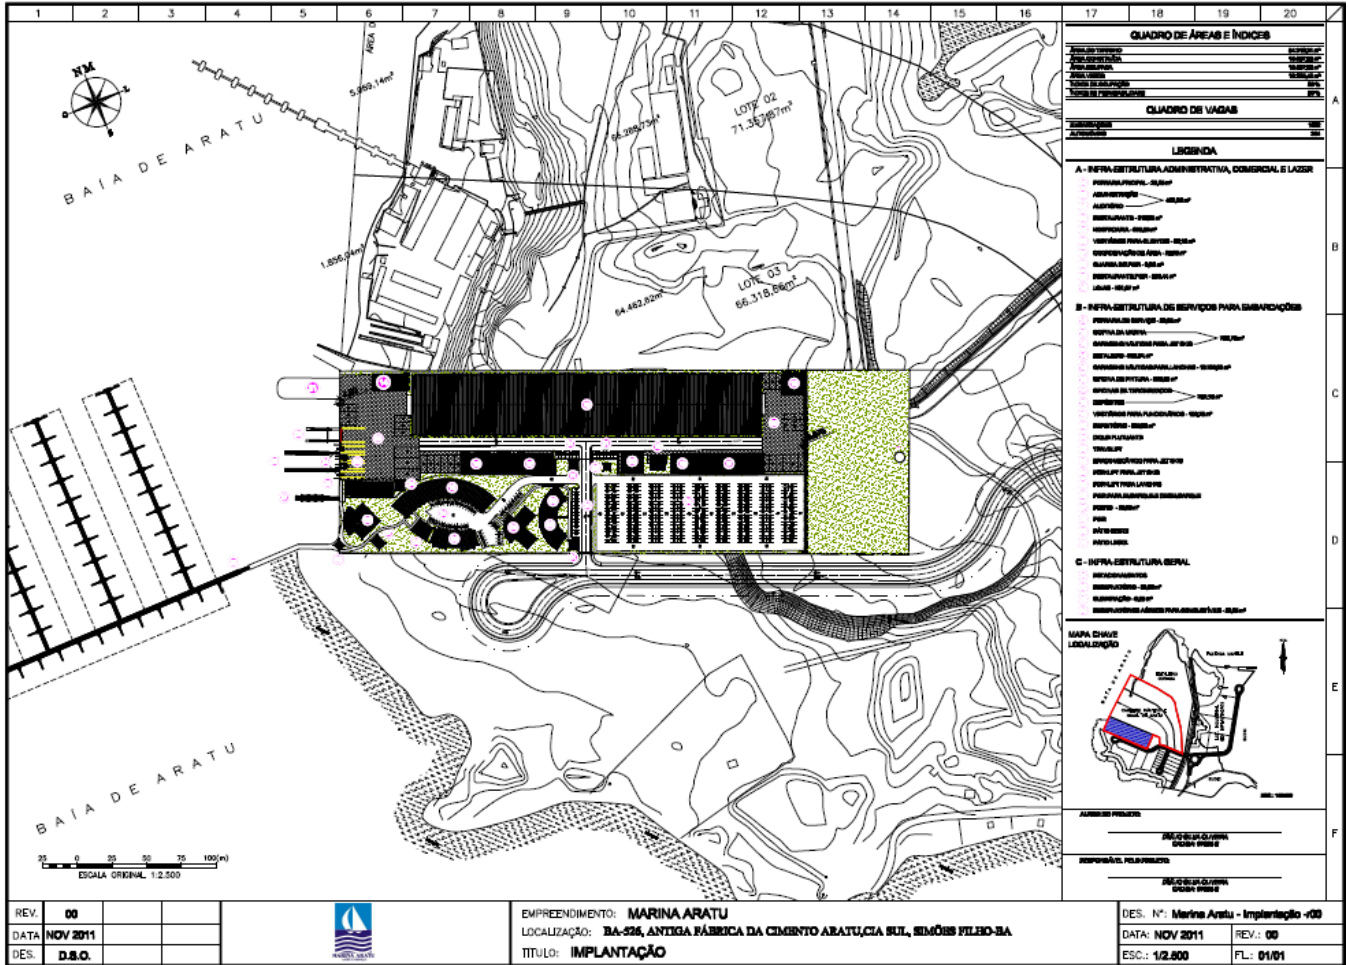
Planta de implantação da MARINA DE ARATU (Anexo 2.4.2.1)
